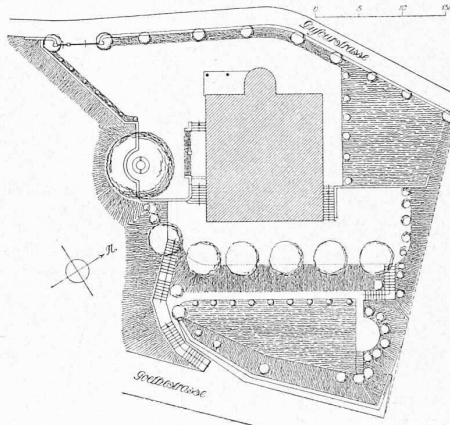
Lageplan der „Laimsburg“. — 1 : 800.
